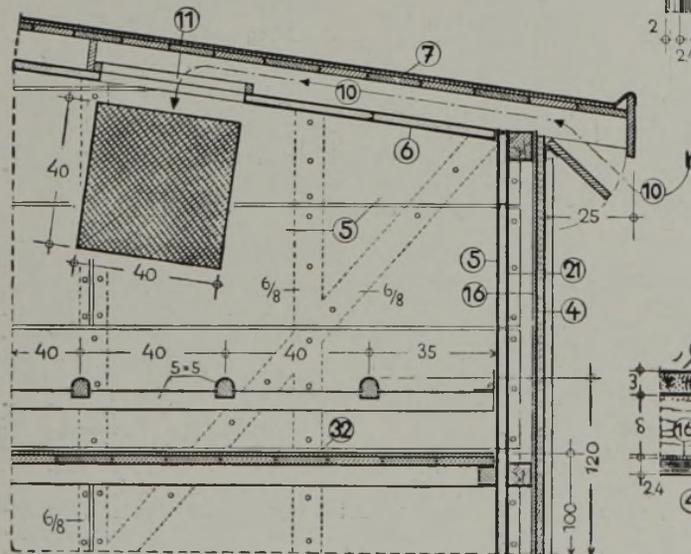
Detail des Schlafraumes mit Wandausführung A, Sitzstangenrahmen tagsüber hochgeklappt.
